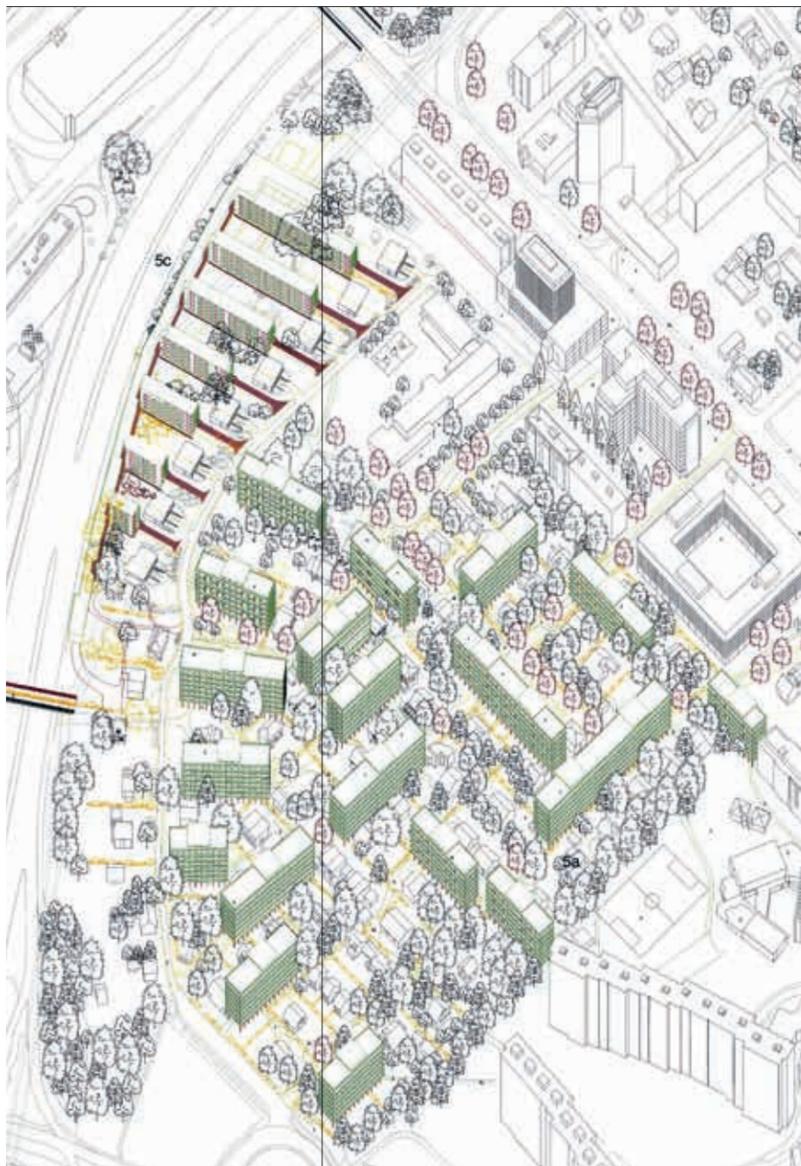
Pont Butin, travaux des étudiantes Jules Coupin, Pierre Verhellen, Maina Cazenave et Alex Collet, Atelier Widmer-Gardelegui, Faculté de l'environnement naturel, architectural et construit (ENAC), EPFL, automne 2024
